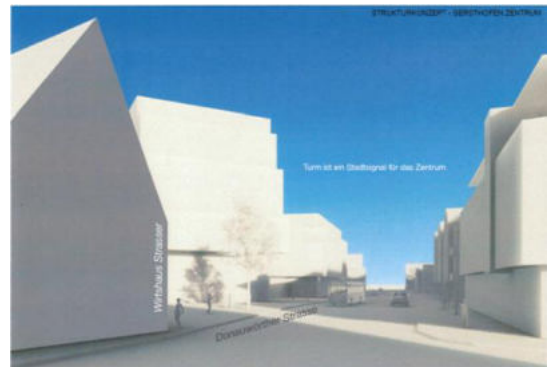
Vorentwurf Februar 2019, Perspektive Kreuzung Augsburg & Donauwörther Straße / Bahnhof- und Bauernstraße, 8 Geschosse
